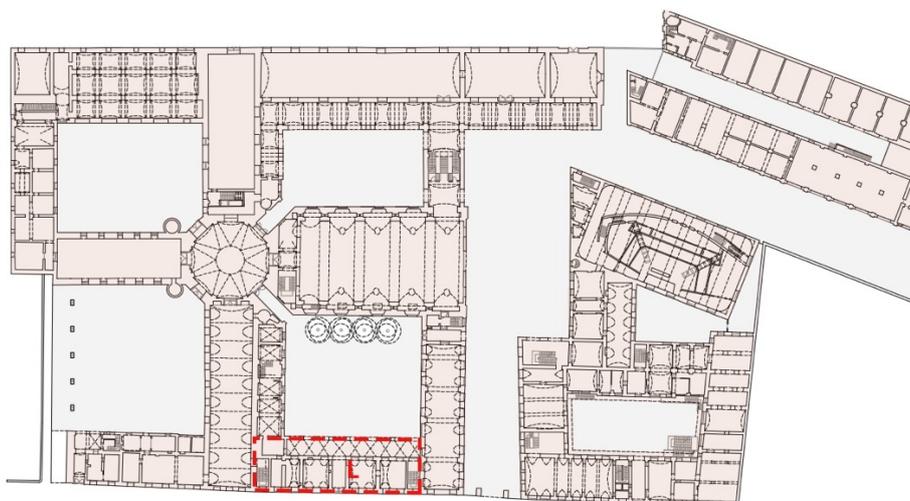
planimetria con evidenza edificio L - elaborazione personale
